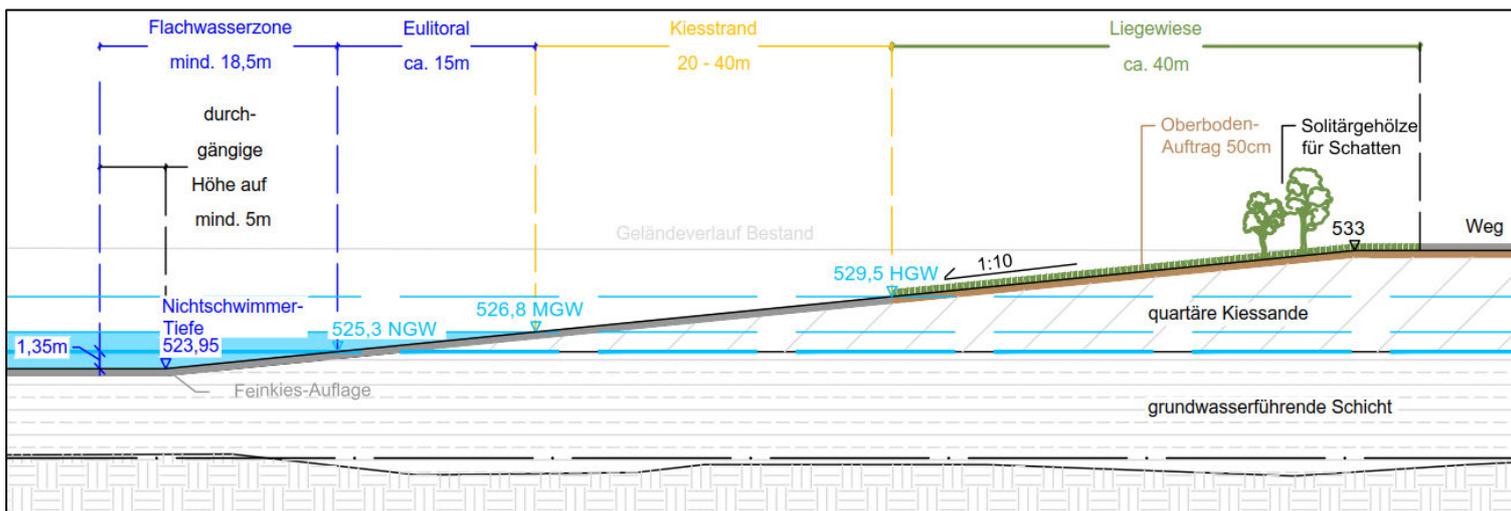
Ausschnitt aus Plan Nr. 06 - Schemaschnitt durch Flachufer, siehe Planunterlagen
